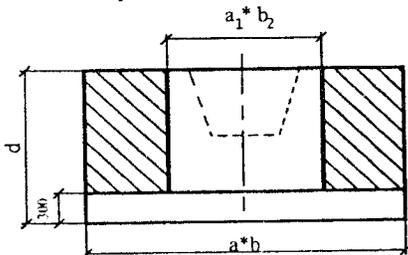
Разрез фундамента столбчатого железобетонного под колонны в двух проекциях:
